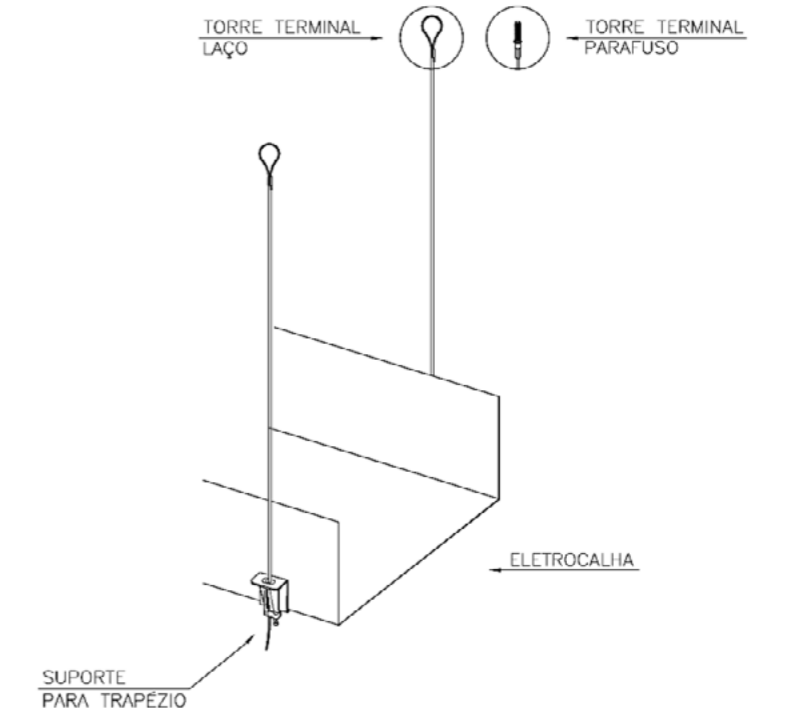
Modelo de fixação de eletrocalha em laje ou estrutura
